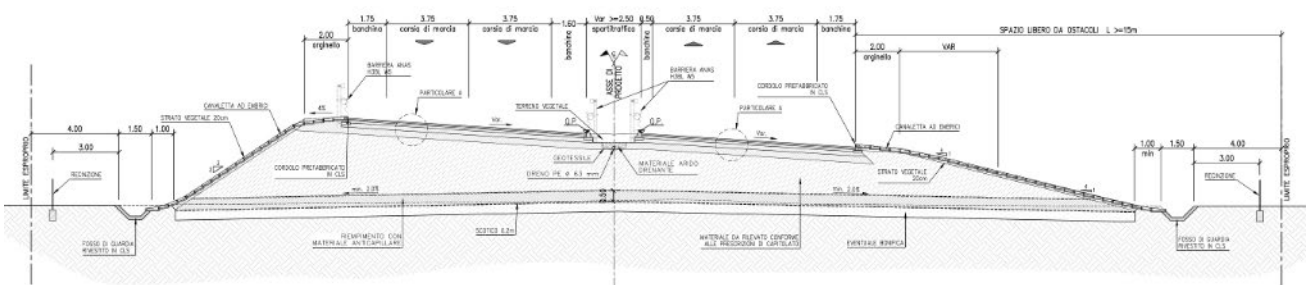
Sezione tipo in rilevato dell'asse principale con corsia di diversione e allargamento per visibilità
